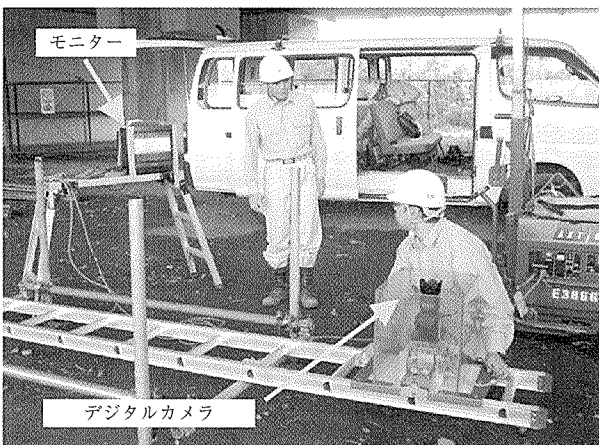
ひび割れ画像撮影状況（拡大）
